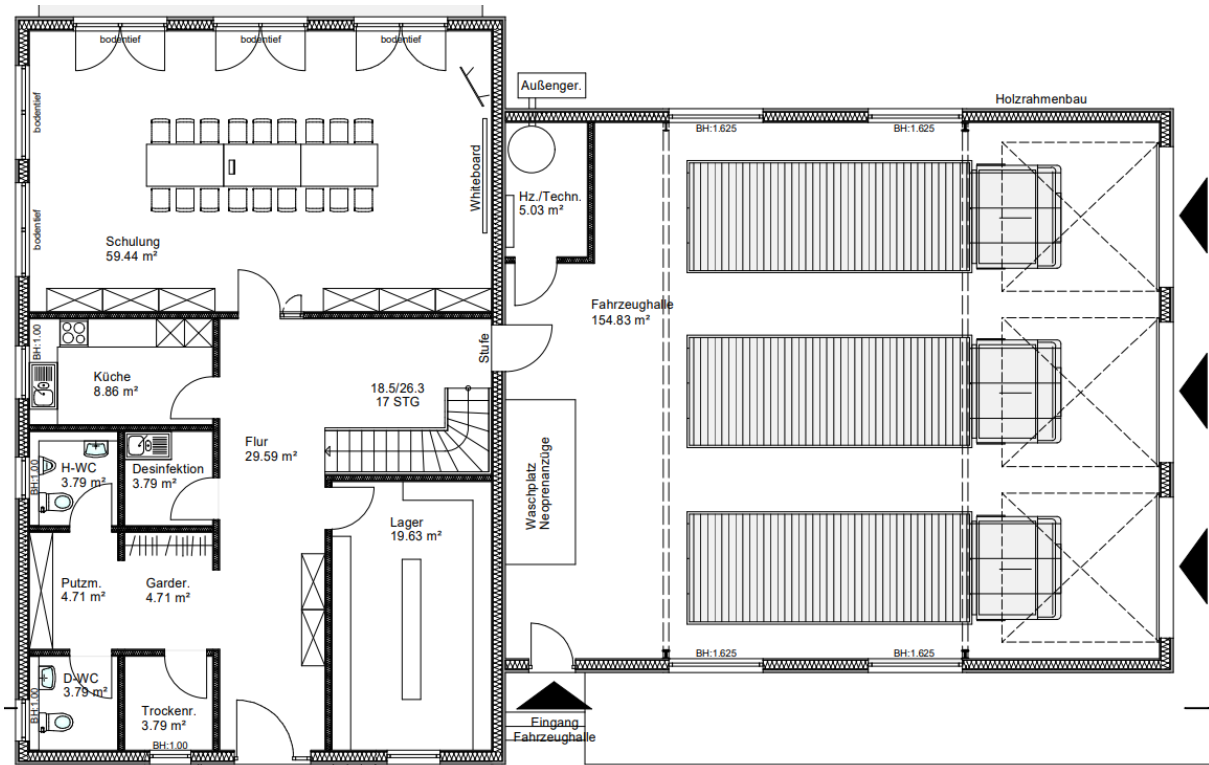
Grundriss Erdgeschoss (Weidling und Partner)
